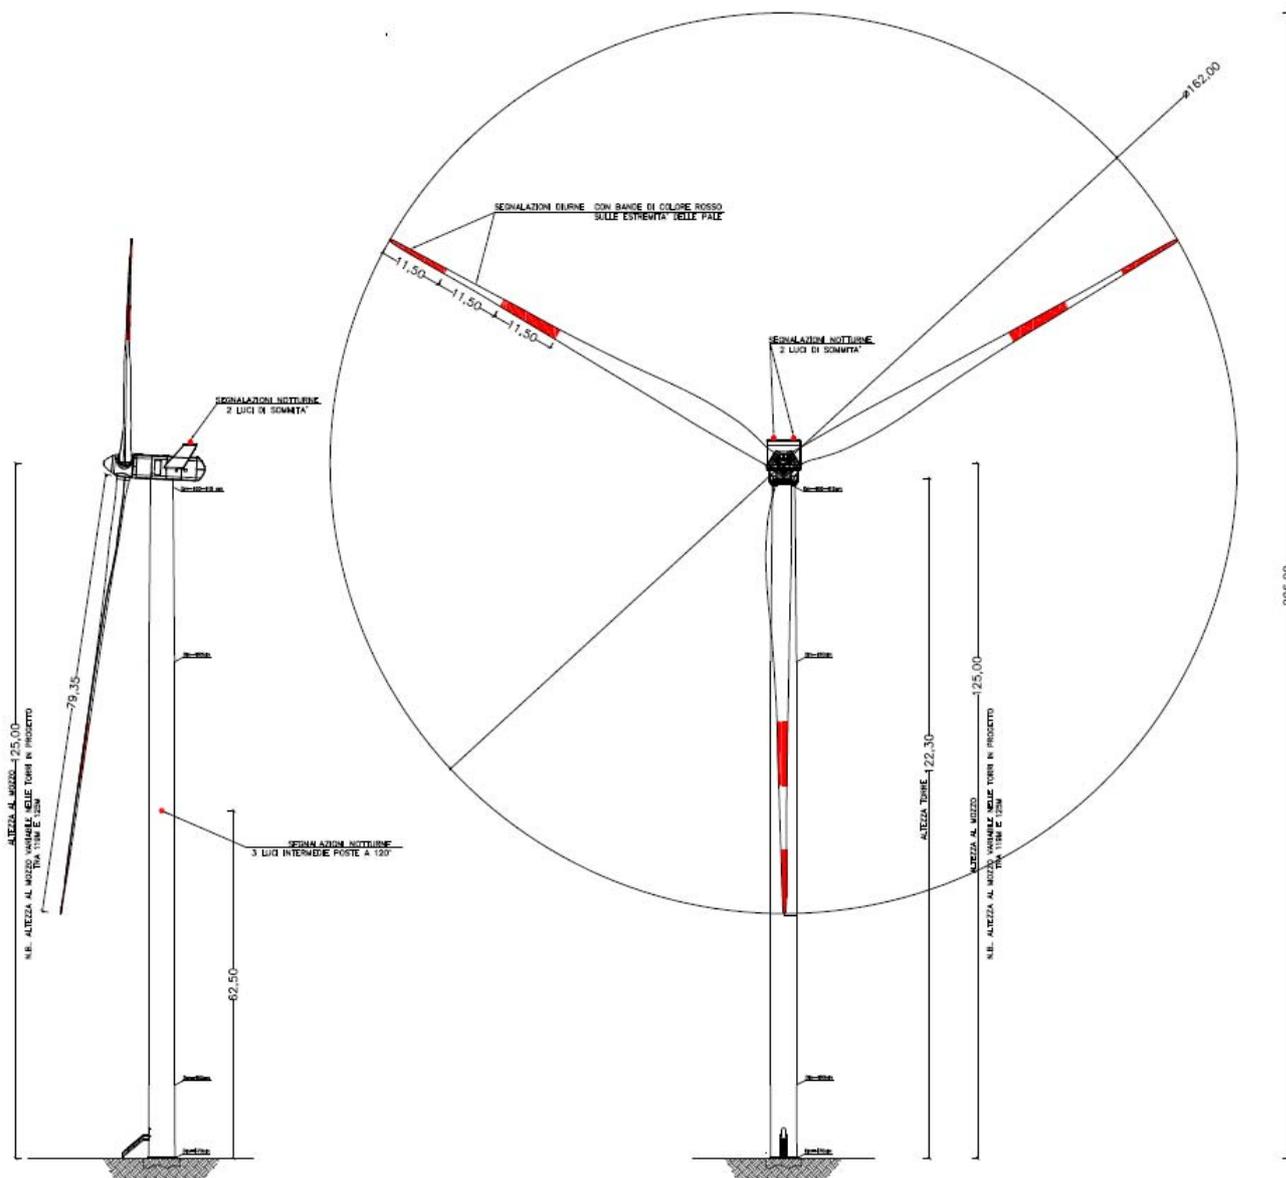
Prospetto e sezione dell'aerogeneratore tipo VESTAS – V162-6 MW
